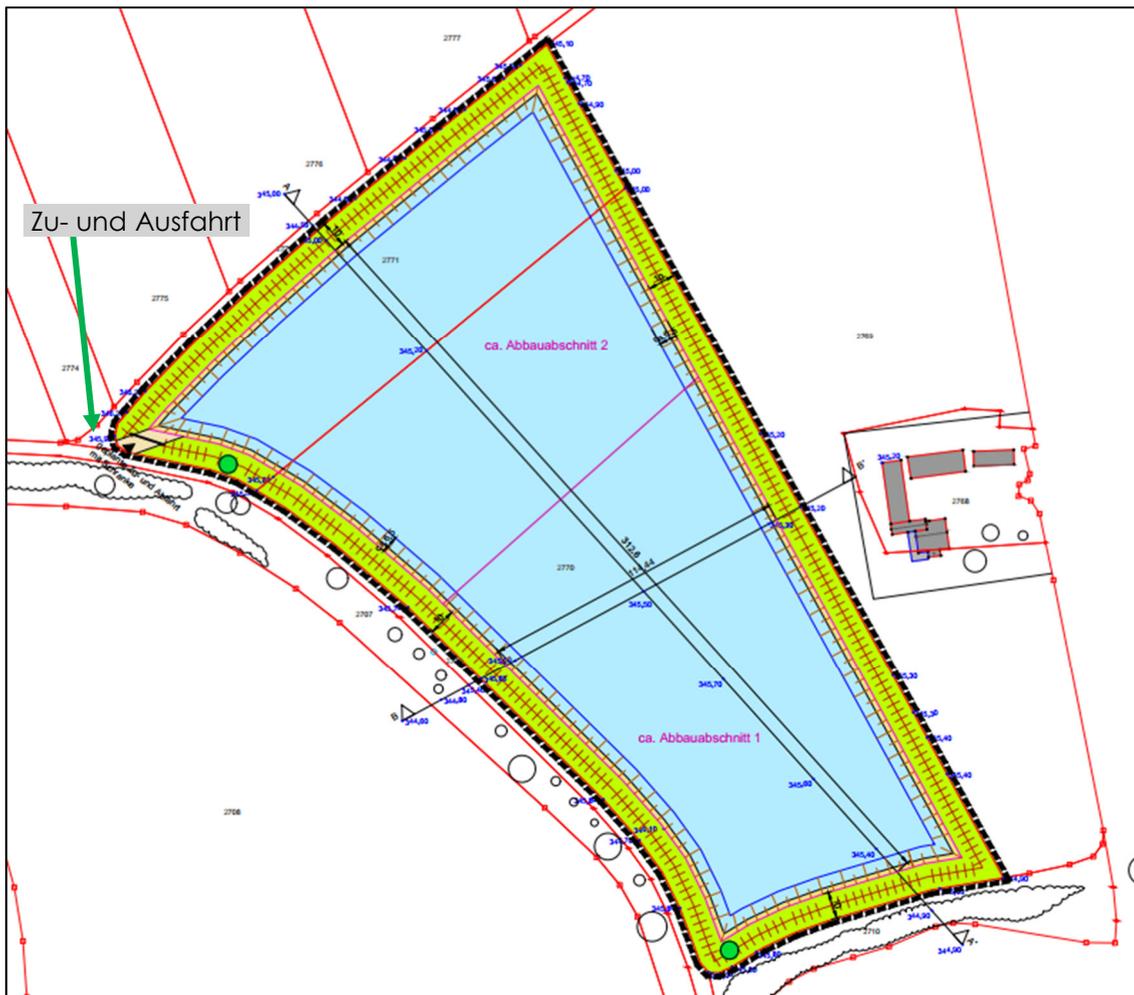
Lageplan mit Darstellung des geplanten Vorhabens /17/
